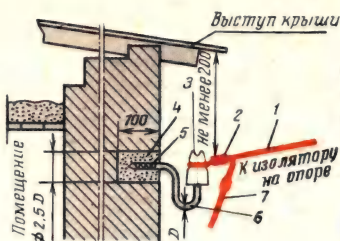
Крепление крюка на кирпичной или бетонной стене:
